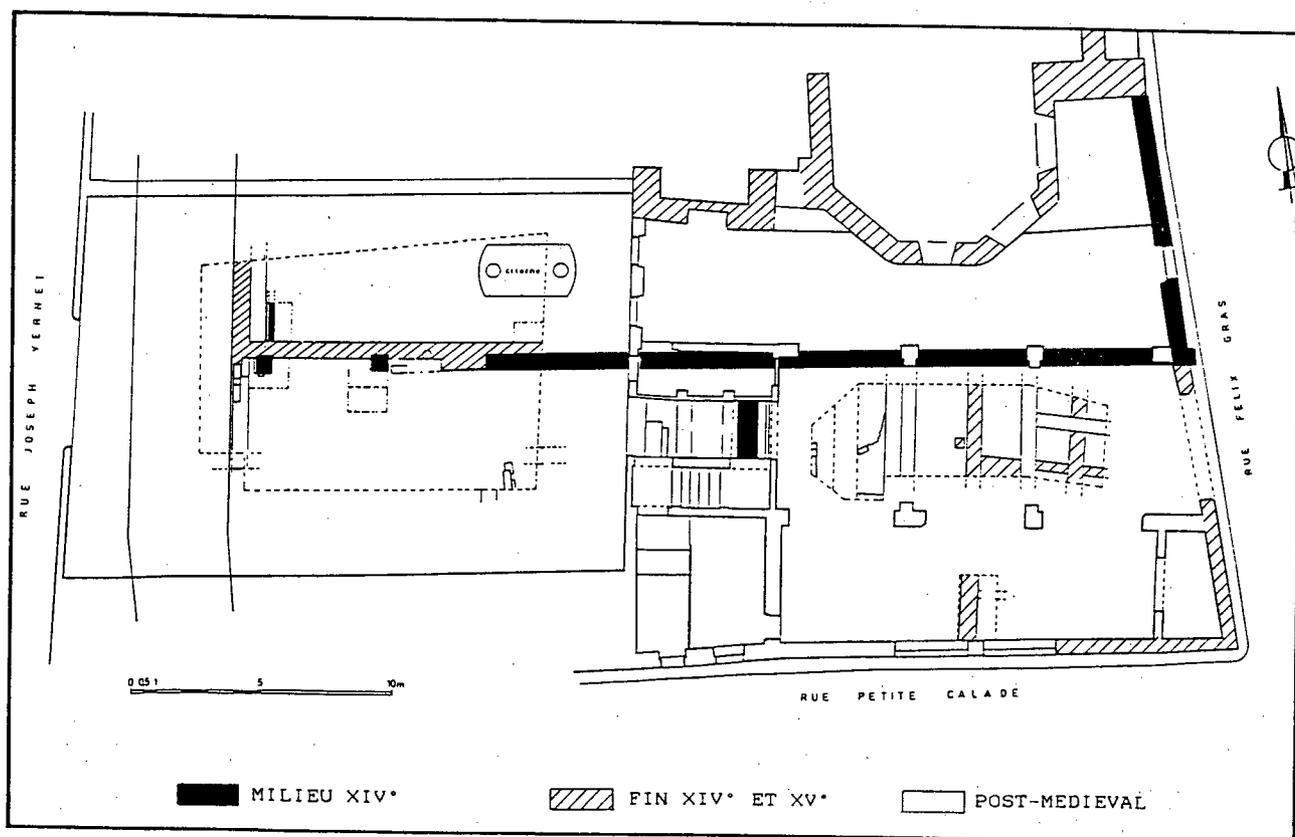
84 - AVIGNON, Rue Joseph Vernet. Plan d'ensemble des structures.
